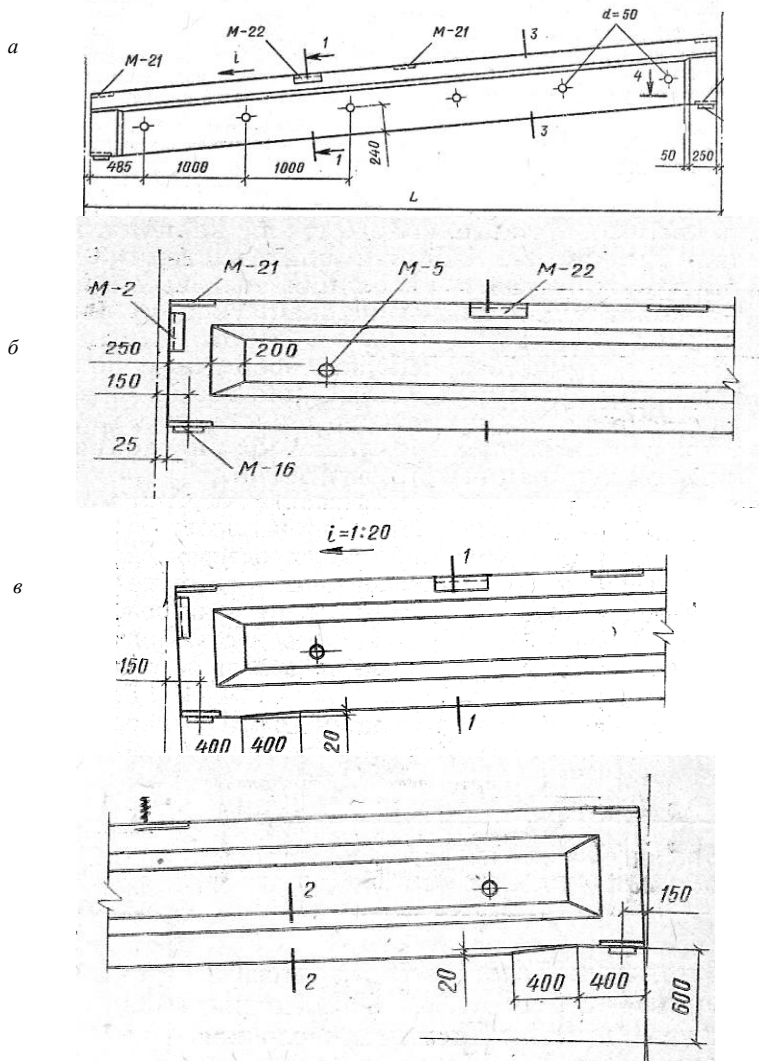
Железобетонные балки пролетом 6, 9 и 12 м:
